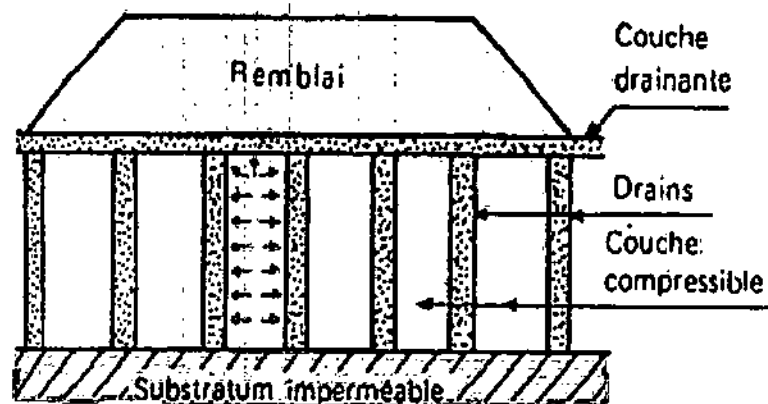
Schéma d'une installation de drains de sable verticaux.
